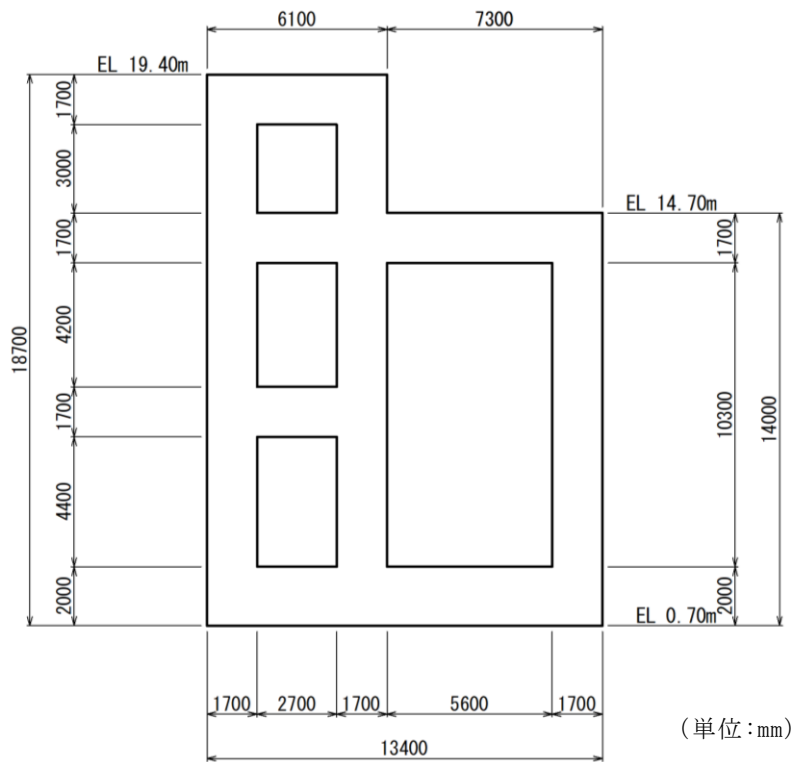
第 1 ベントフィルタ格納槽 断面図 (A-A 断面)
